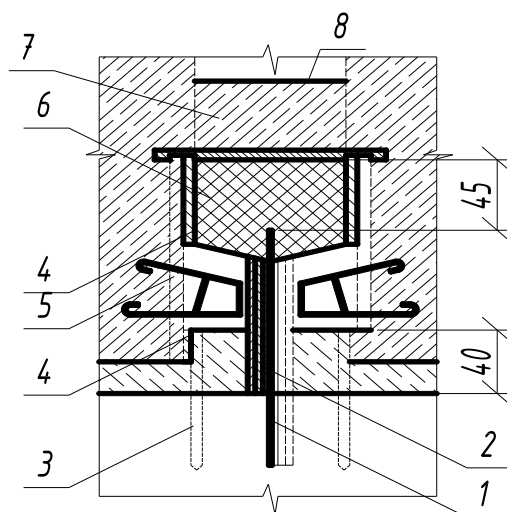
З'єднання шпунта з фундаментною плитою за допомогою шпонки:
